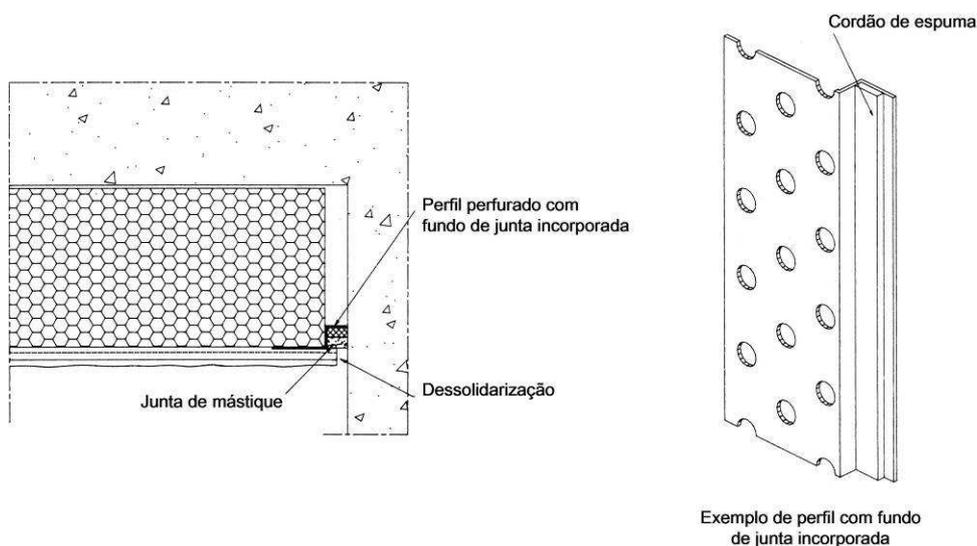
Ligação do sistema com elementos construtivos salientes (corte horizontal) [3]
